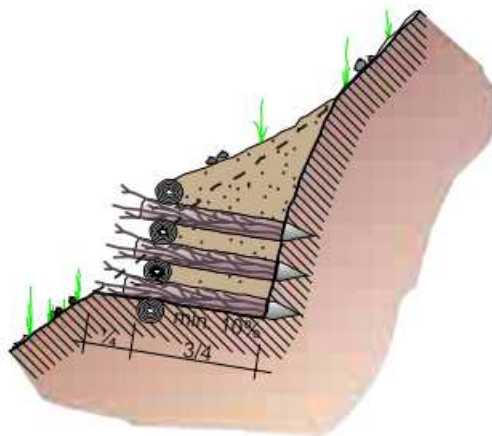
Muro cellulare in legname a parete semplice.
